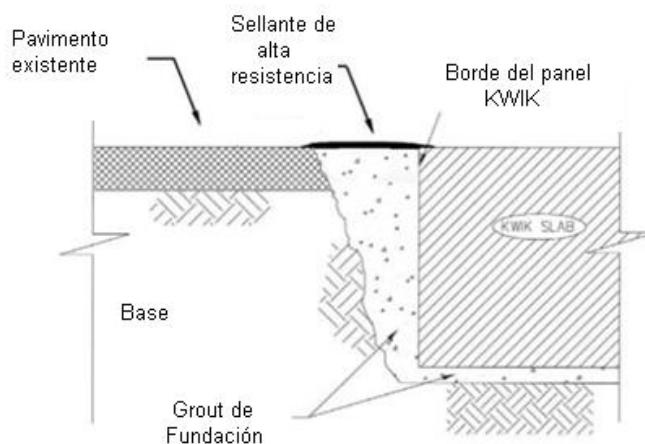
Esquema unión entre pavimento existente y panel Kwik Slab.
